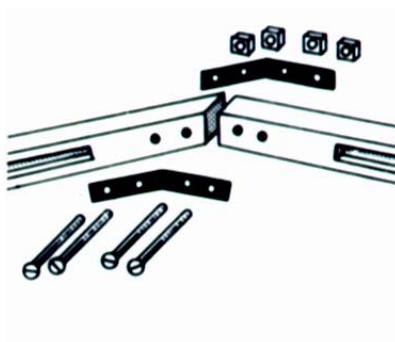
Ligação viga-viga - chapa fixada nas faces laterais das vigas.
